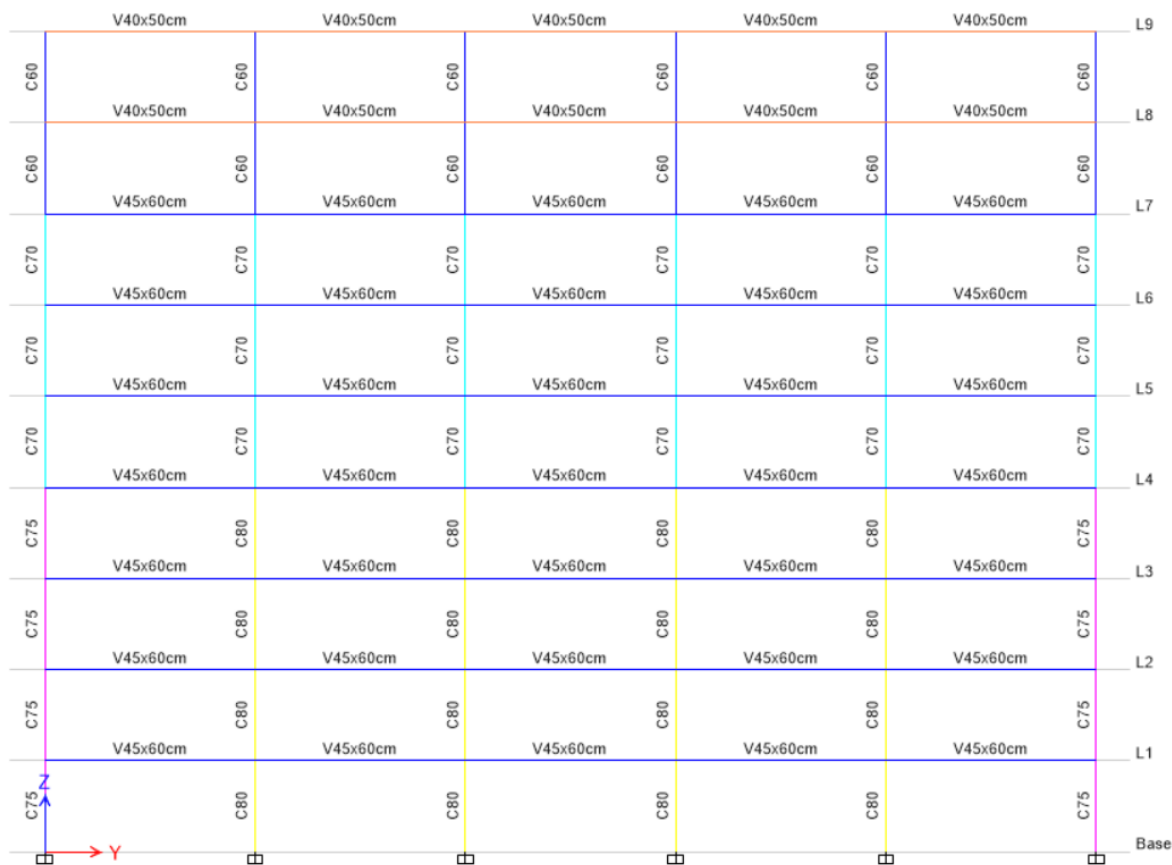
Configuración de un pórtico interior de las secciones para un edificio de 9 pisos. Para los pórticos exteriores e interiores en una vista x-z, se mantiene las mismas configuraciones que se utilizó para los pórticos en una vista y-z.
